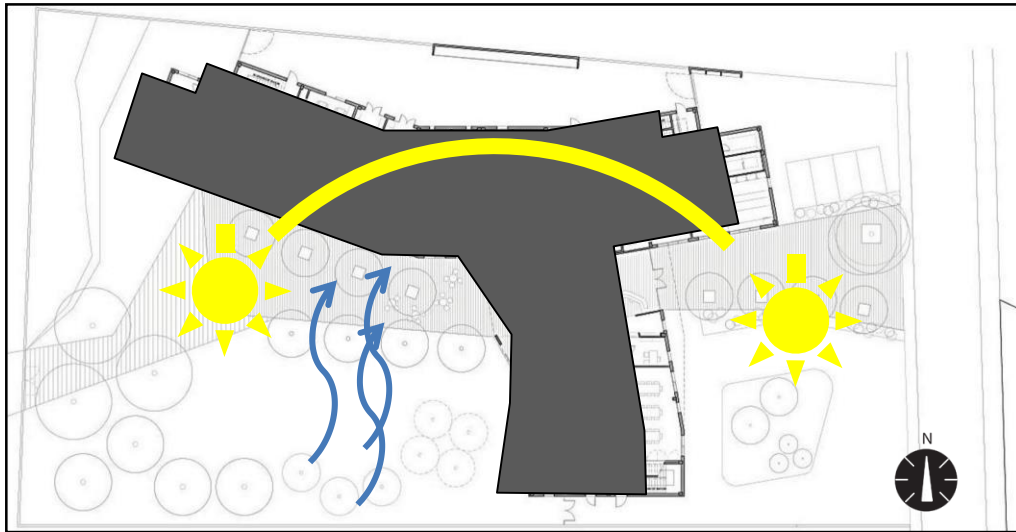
Planta emplazamiento proyecto Centro de día y Residencia
